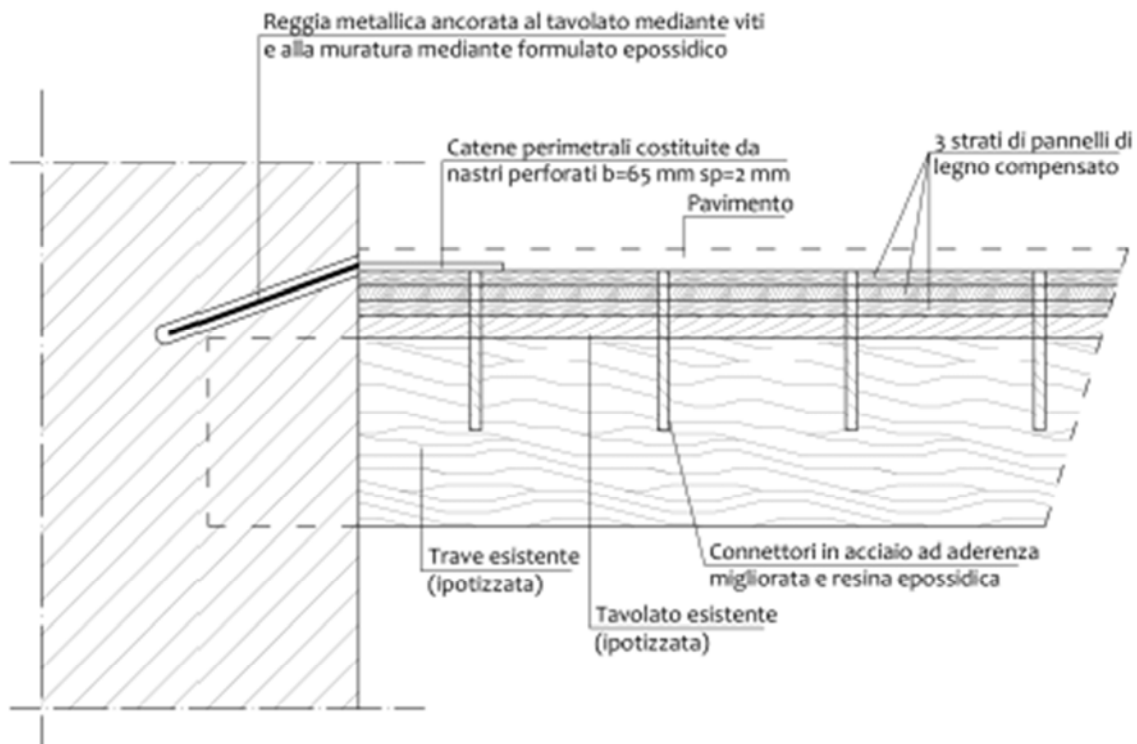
Schematizzazione del posizionamento della reggia metallica in sezione longitudinale del solaio.
